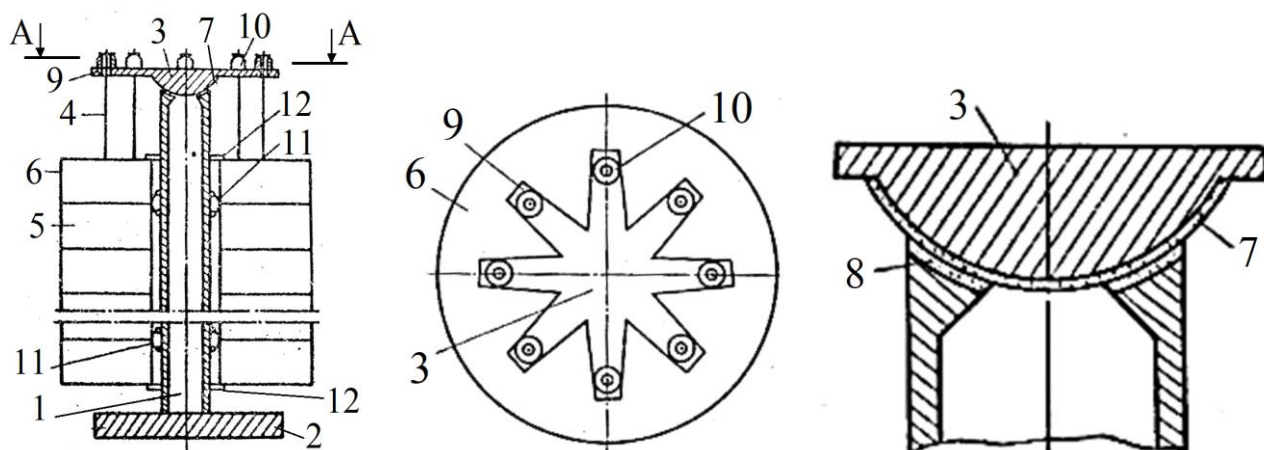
Многоэтажное сейсмостойкое здание: 1 – несущий ствол; 2 – фундамент; 3 – оголовок; 4 – подвески; 5 – этажные конструкции; 6 –этажный блок; 7 – опорная поверхность оголовка; 8 – ответная поверхность ствола; 9 – балки; 10 – опоры подвесок; 11 – амортизаторы; 12 – включающиеся связи
